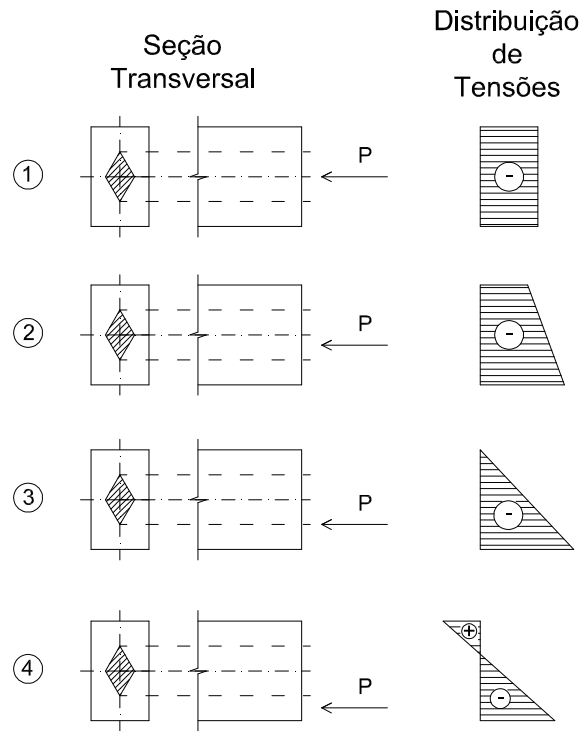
Viga isostática submetida à protensão excêntrica.
